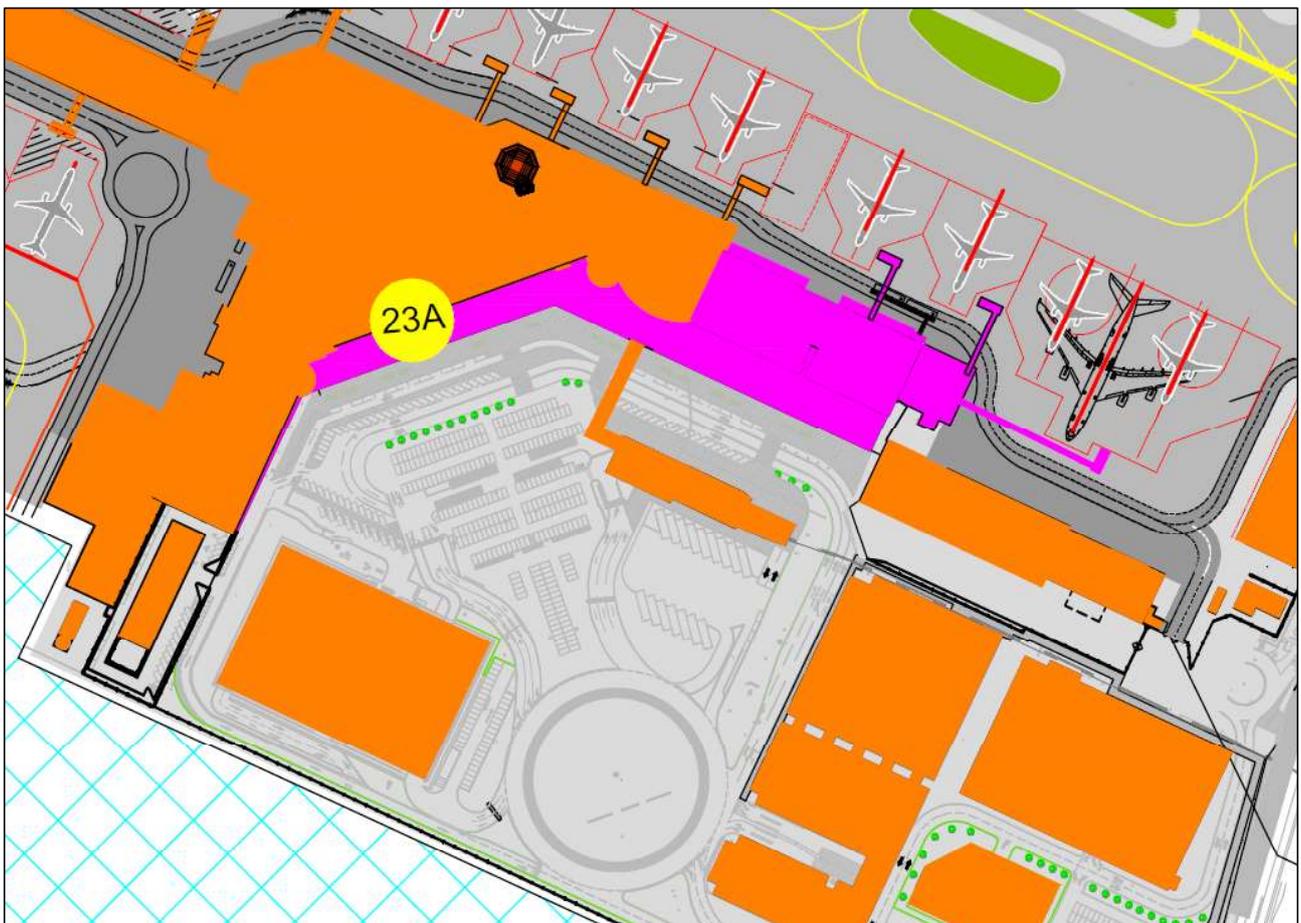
Estratto Master Plan – Ampliamento Aerostazione Est
